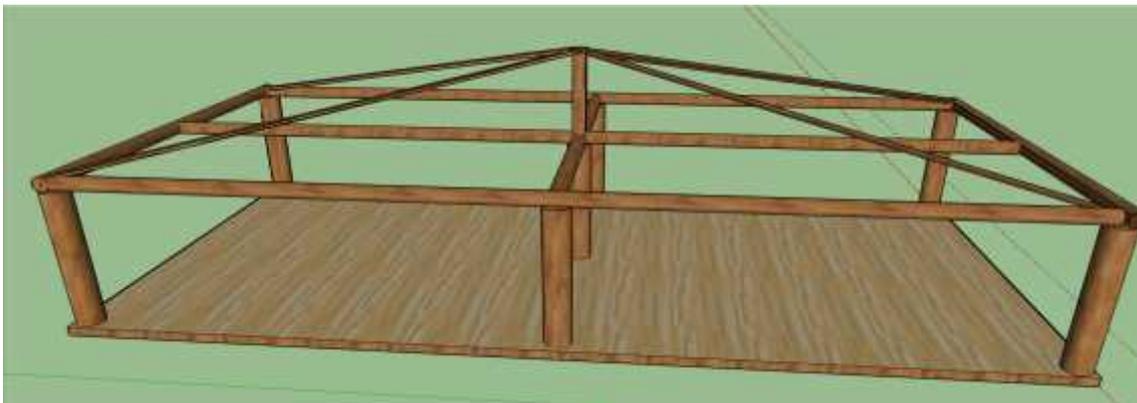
Vista Interna de las Cuatro Vigas del Alojamiento Indígena. El Autor (2017)
